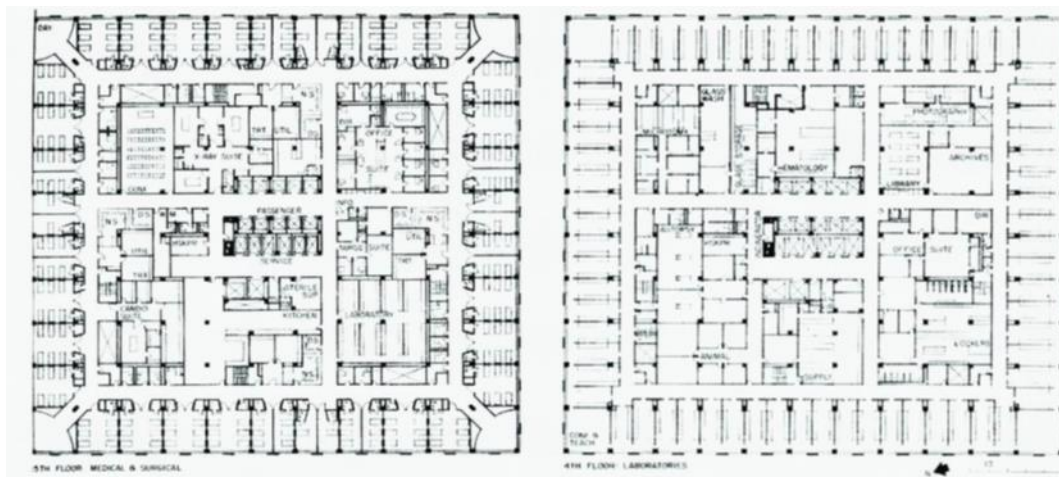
Plantas baixas do 15 e 4 pavimentos do Hospital Bellevue. Fonte: Verderber e Fine, 2000.
